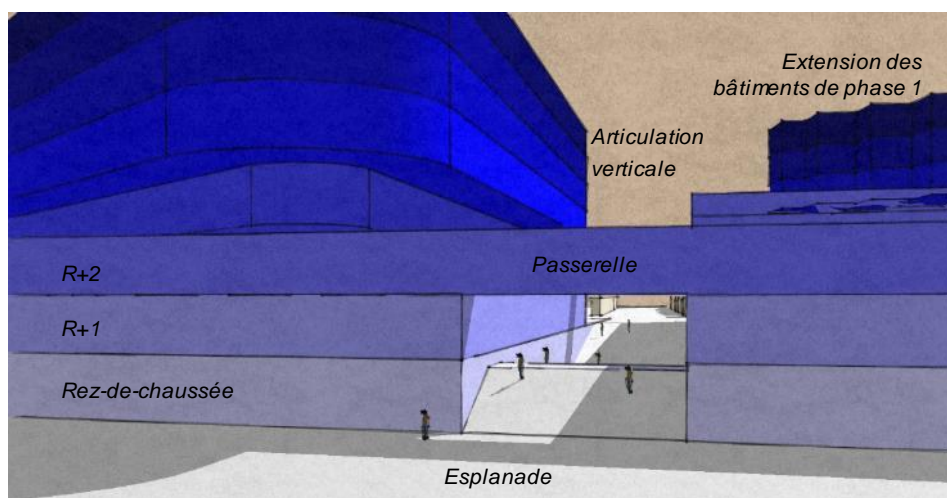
Vue sur la travée et les rampes permettant de franchir le dénivelé et le couloir prévu au rez-de-chaussée pour rejoindre l'accueil (source : Stratec)
